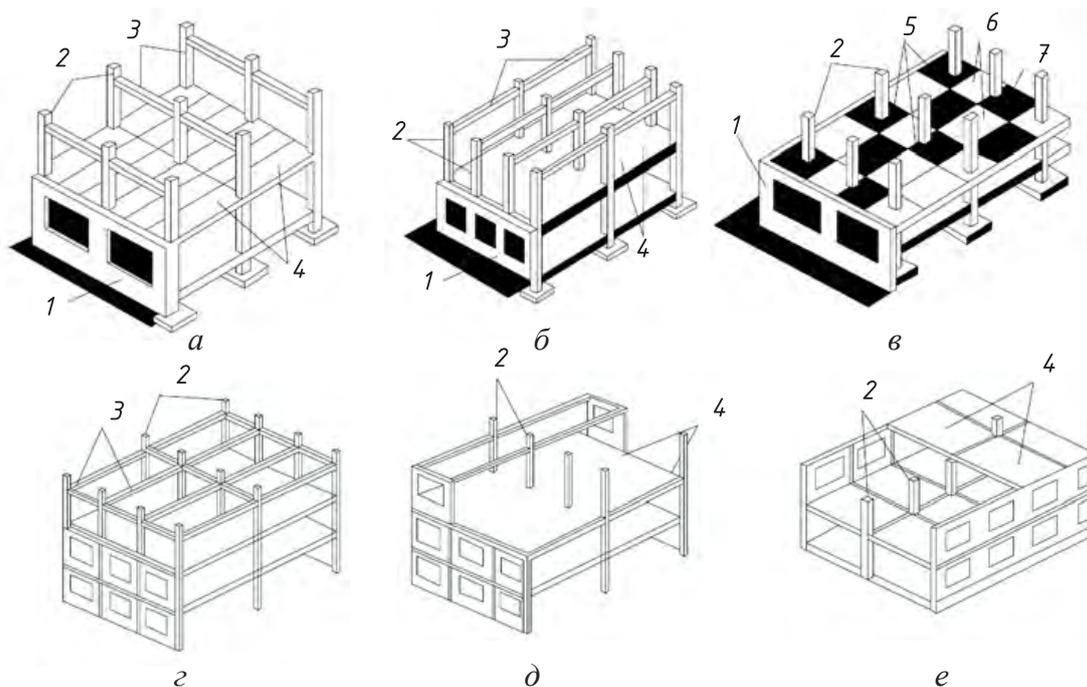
Конструктивные типы каркасных зданий: *а* — с продольным расположением ригелей; *б* — с поперечным расположением ригелей; *в* — безригельное решение; *г* — с пространственным каркасом; *д* — с неполным поперечным каркасом и несущими наружными стенами; *е* — с опиранием панелей на наружные панели и две стойки по внутреннему ряду: 1 — самонесущие стены; 2 — колонны; 3 — ригели; 4 — плиты междуэтажных перекрытий; 5 — надколонная плита перекрытия; 6 — межколонные плиты; 7 — панель-вставка
